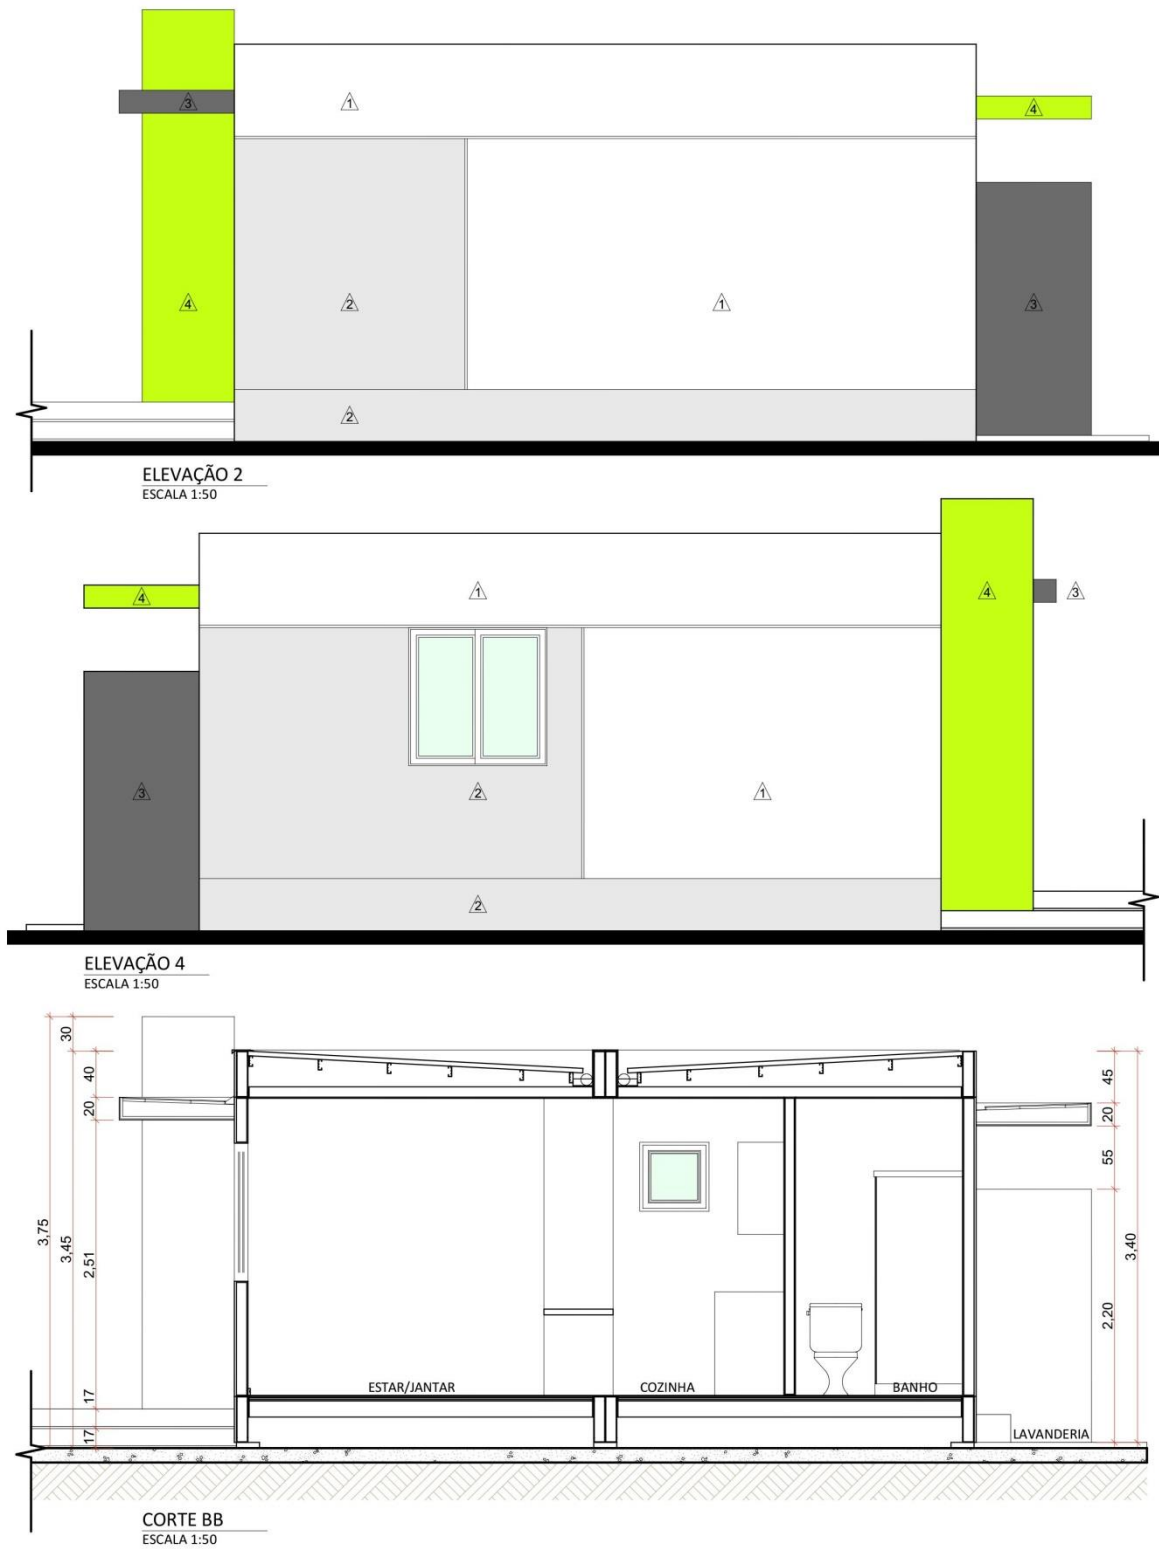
Elevações 2 e 4 e Corte BB da casa de steel frame. Fonte: Modulare Engenharia, 2013.
